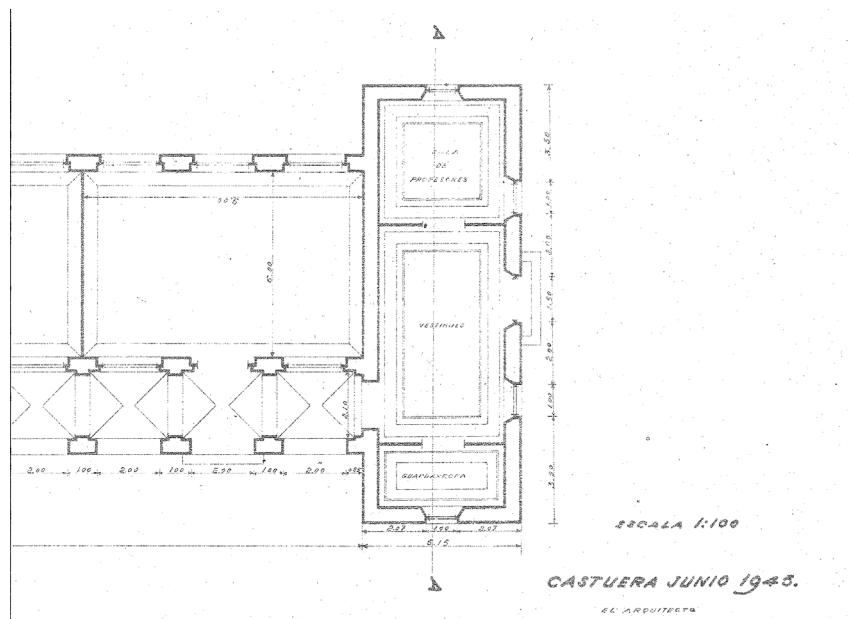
Plano de "Reconstrucción y Reforma". Detalle de Cerramiento Proyecto de Construcción de Escuelas para Medellín (Badajoz)
